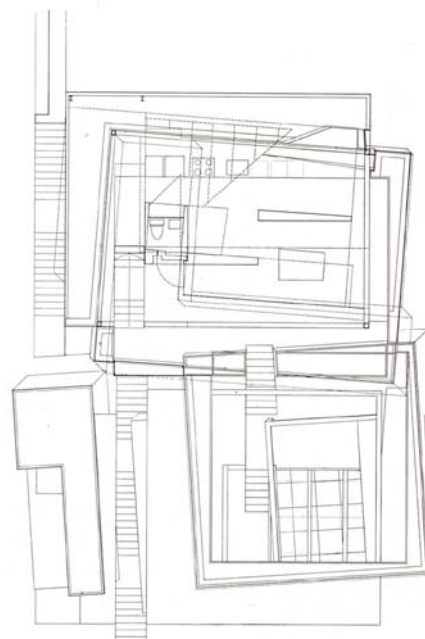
Planta Fundações (Levene, et al., 1989 p. 74)
